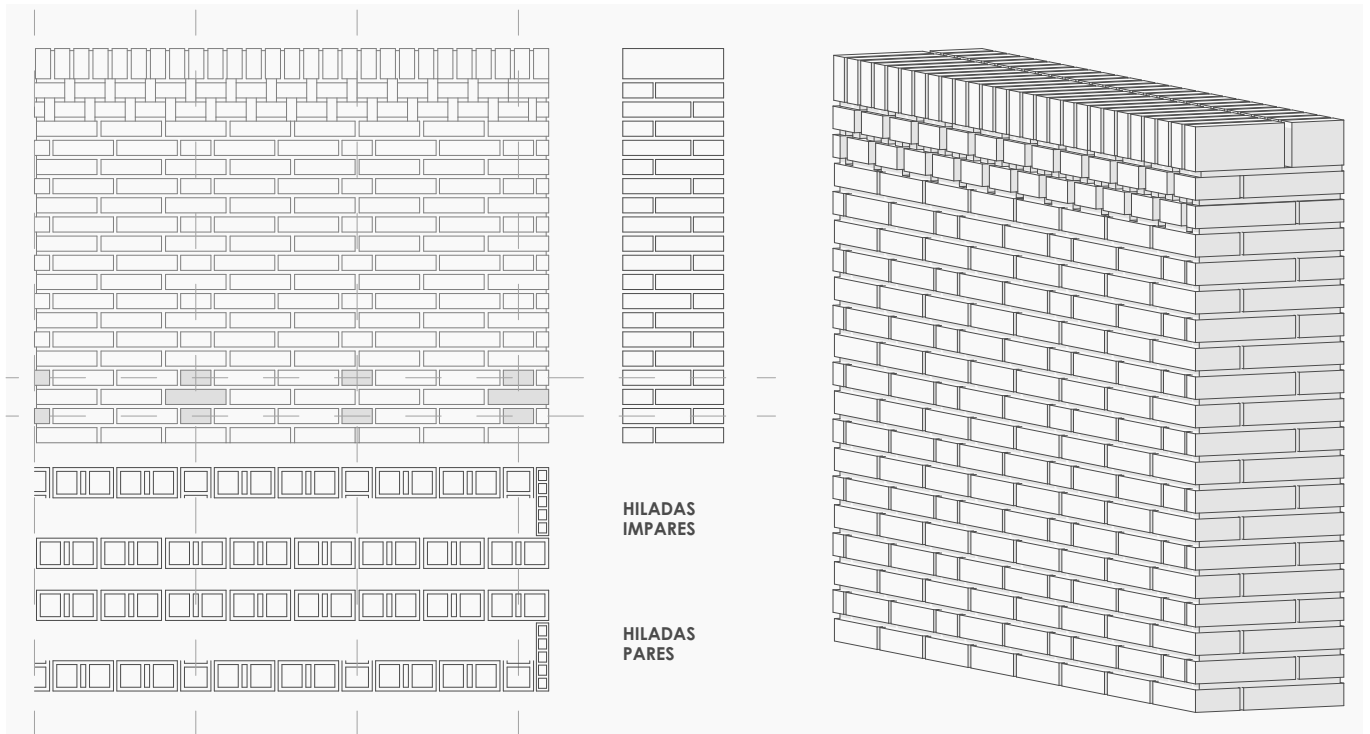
Ilustración del ladrillo en el detalle constructivo 3'.
